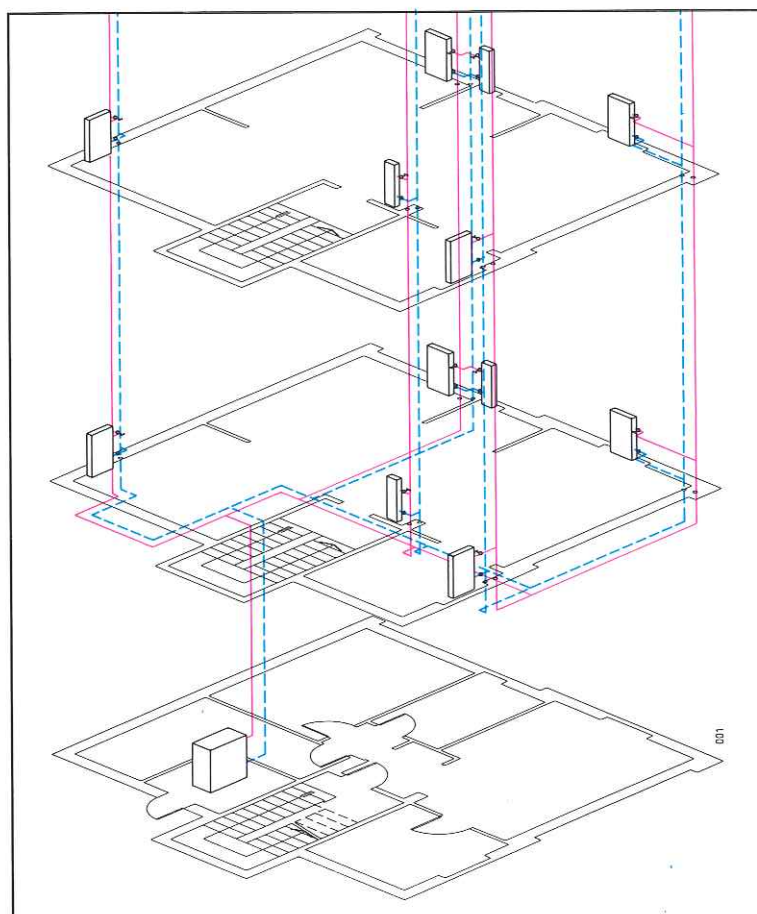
Impianto centralizzato a distribuzione verticale a due tubi con distribuzione dal basso (a sorgente)
